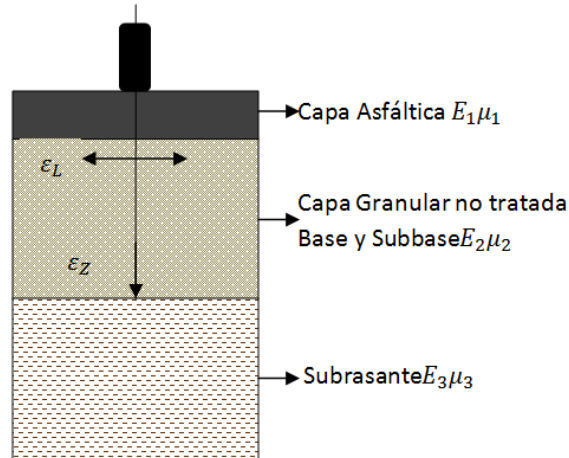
Sistema Multicapa Elástico para el Diseño de Pavimentos Flexibles.
